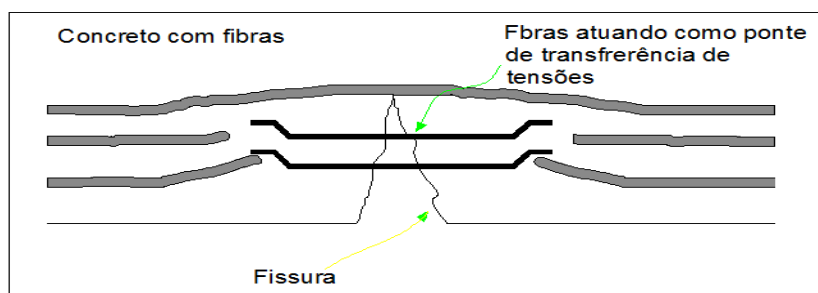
Propagação de fissuras e concentrações de tensões. (RAMOS, 2002)
